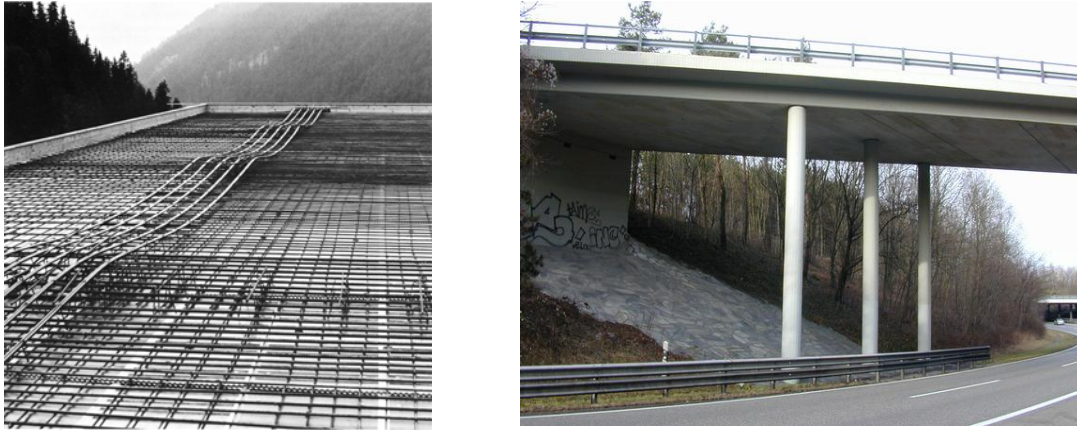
Dalle avec câbles de précontrainte en phase de construction et exemple de pont-dalle précontraint sur l'autoroute A1 près de Genève
